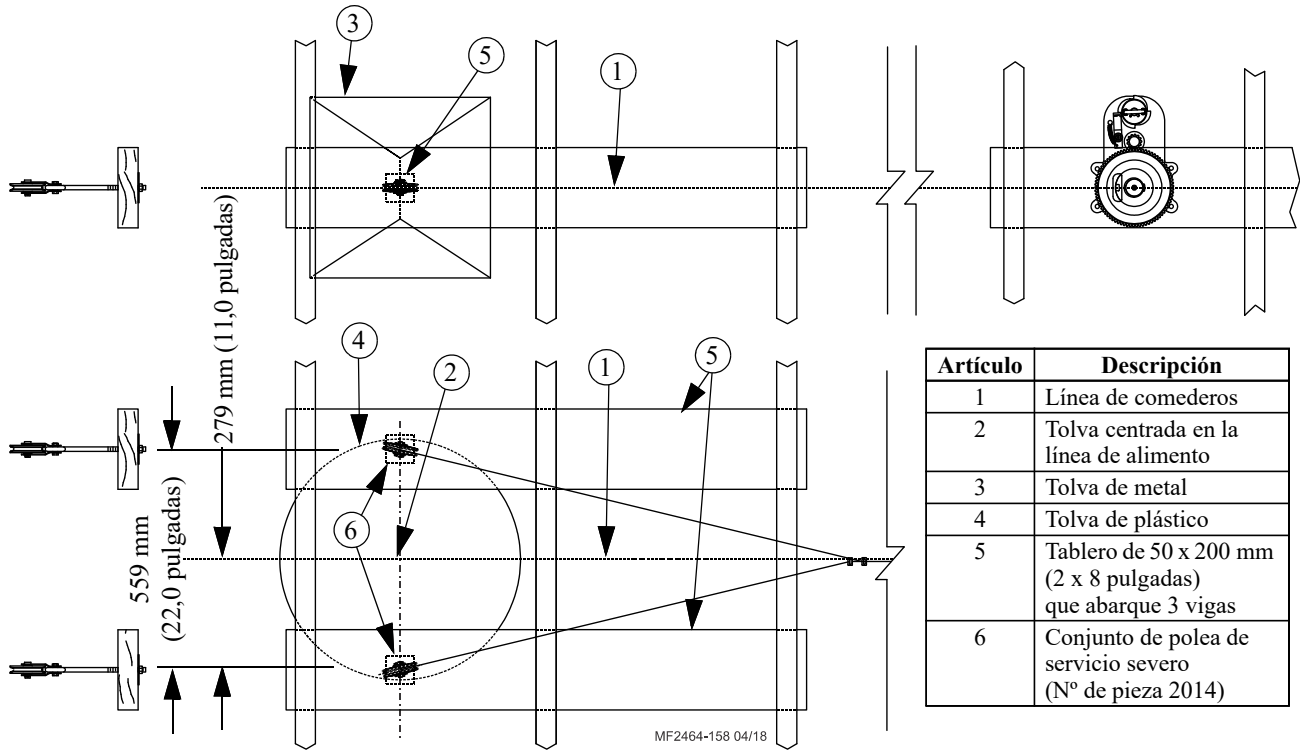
Instalación de cables en ubicaciones de tolvas (construcciones de madera)
